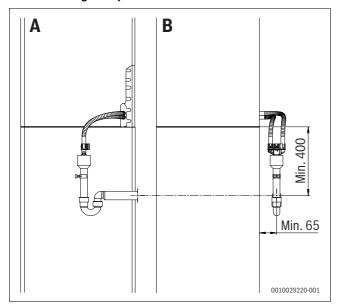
A : vue côté droit (dimensions en mm) B : vue avant (dimensions en mm)
